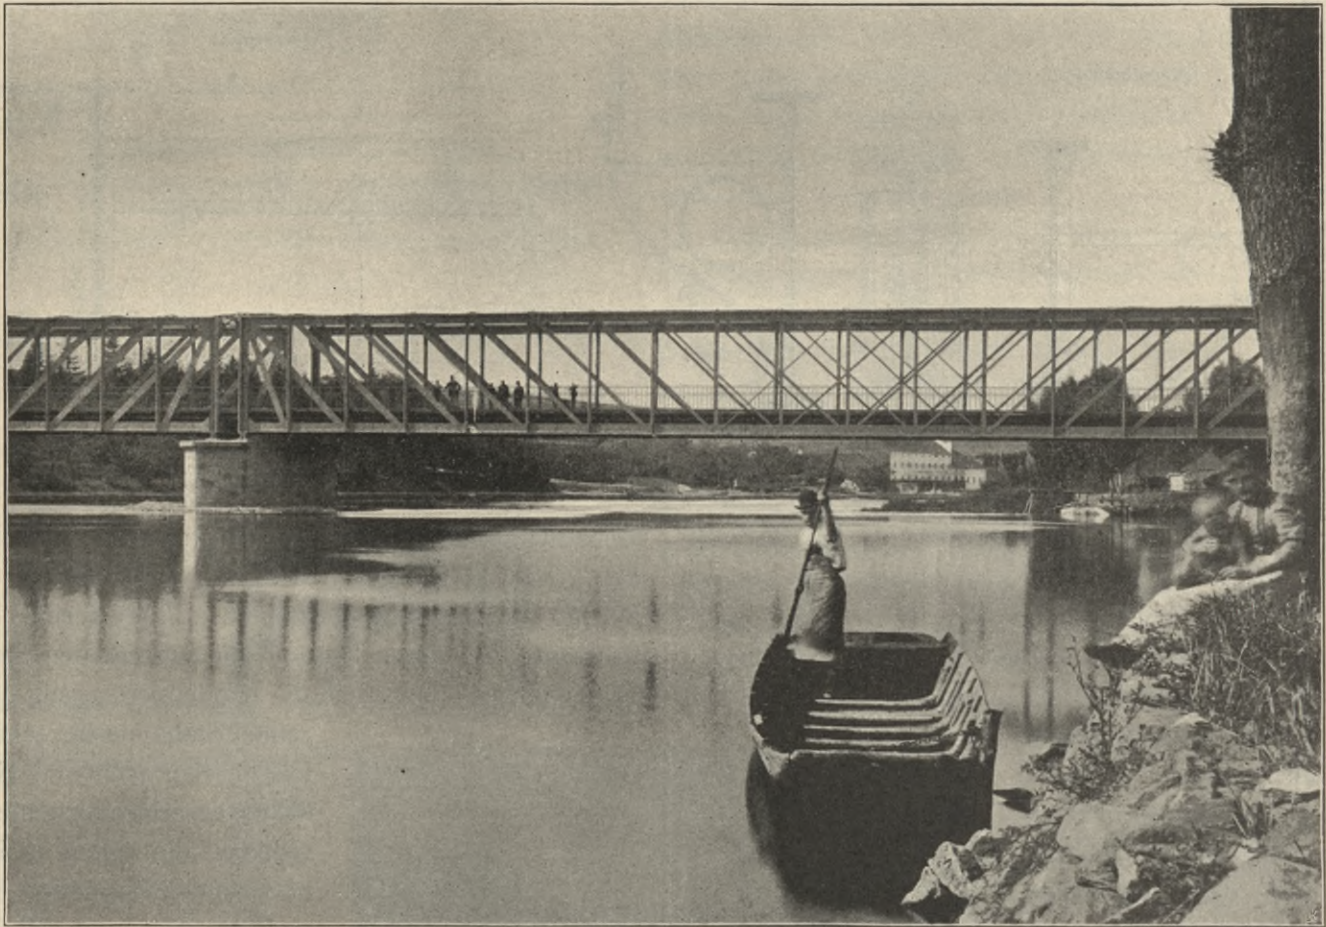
Parallelträger mit über 2 Felder reichenden Diagonalen (Strassenbrücke in Moldautein. 2 Öffn. zu je 59,6 m St. W.).
